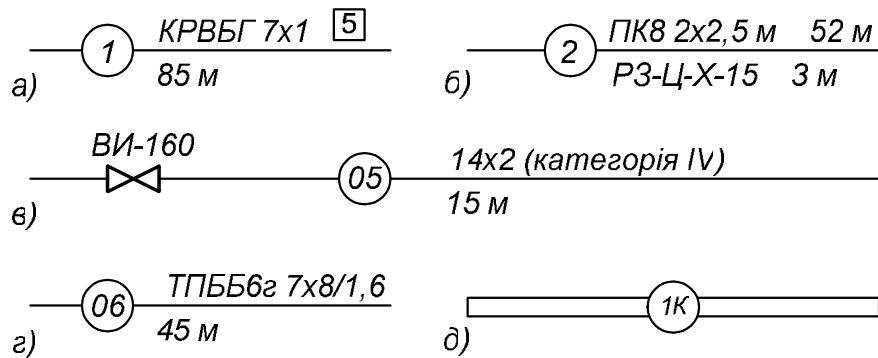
Позначення кабелів та труб на схемі з'єднань зовнішніх проводок.
